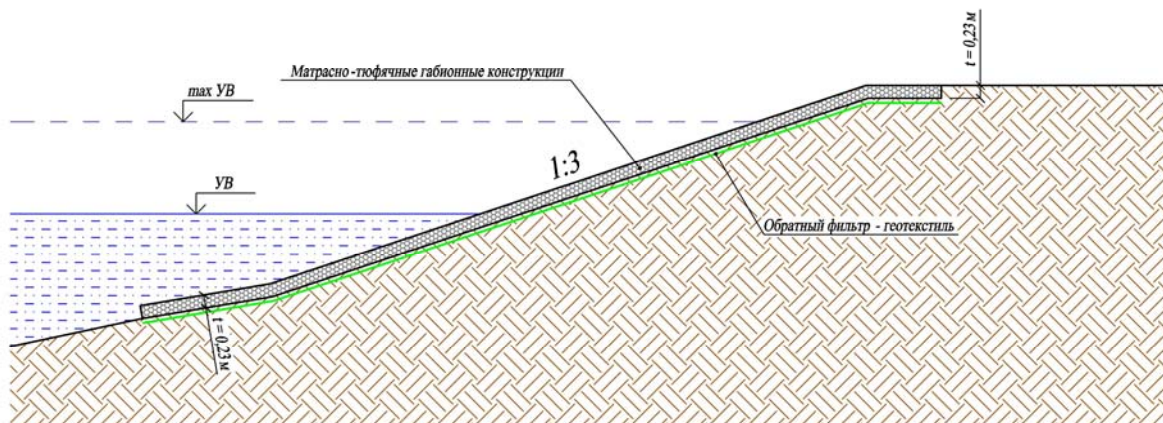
Схема к расчету берегоукрепительного сооружения
